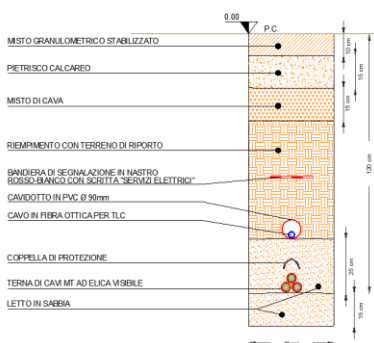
Sezione tipo di scavo per la posa del cavidotto su strada esistente. I cavi elettrici, rispetto ai piani finiti di strade o piazzali o alla quota del piano di campagna, saranno posati negli scavi alla profondità di circa 1,00-1,20m.
